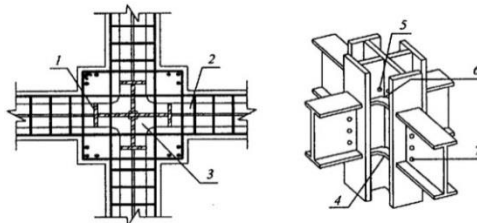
Узел соединения колонны с балкой: 1 - профиль в колонне; 2 - профиль в балке; 3 - бетонное ядро; 4 - горизонтальное нижнее ребро с отверстиями для выхода воздуха; 5 - отверстие в профиле колонны; 6 - горизонтальное верхнее ребро с отверстиями для выхода воздуха; 7 - монтажные отверстия в балке
